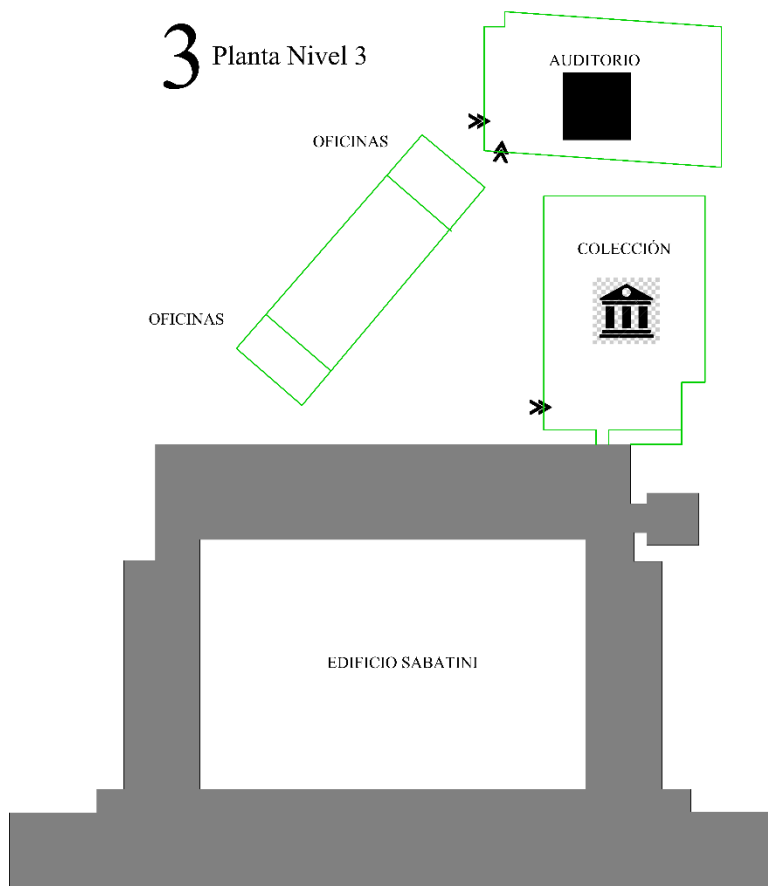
Planta Nivel 3, Museo Reina Sofía - Elaboración Propia
